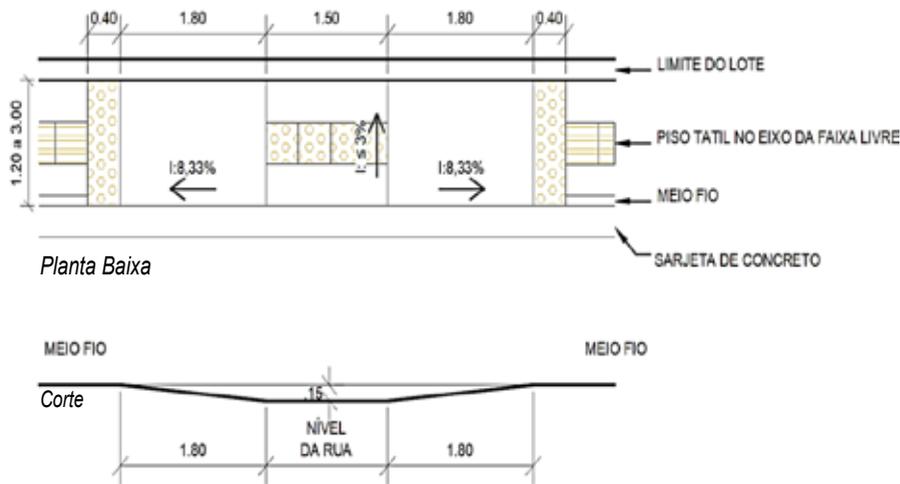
Planta baixa e corte da Rampa Longitudinal para Calçada com altura de 18 cm
